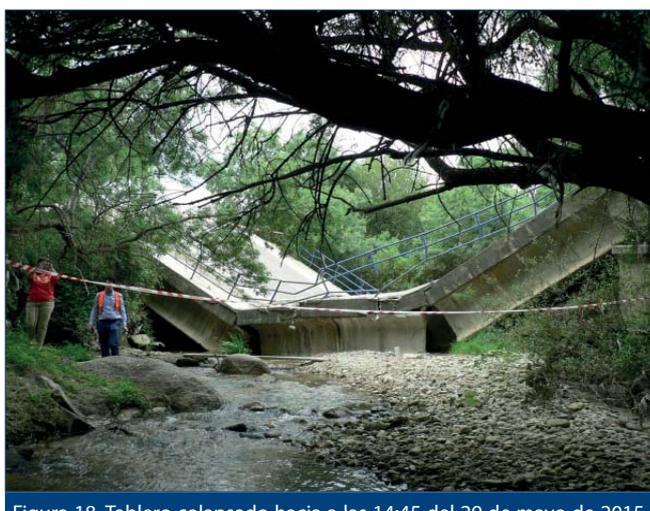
Tablero colapsado hacia a las 14:45 del 29 de mayo de 2015. Vista desde lado izquierdo
